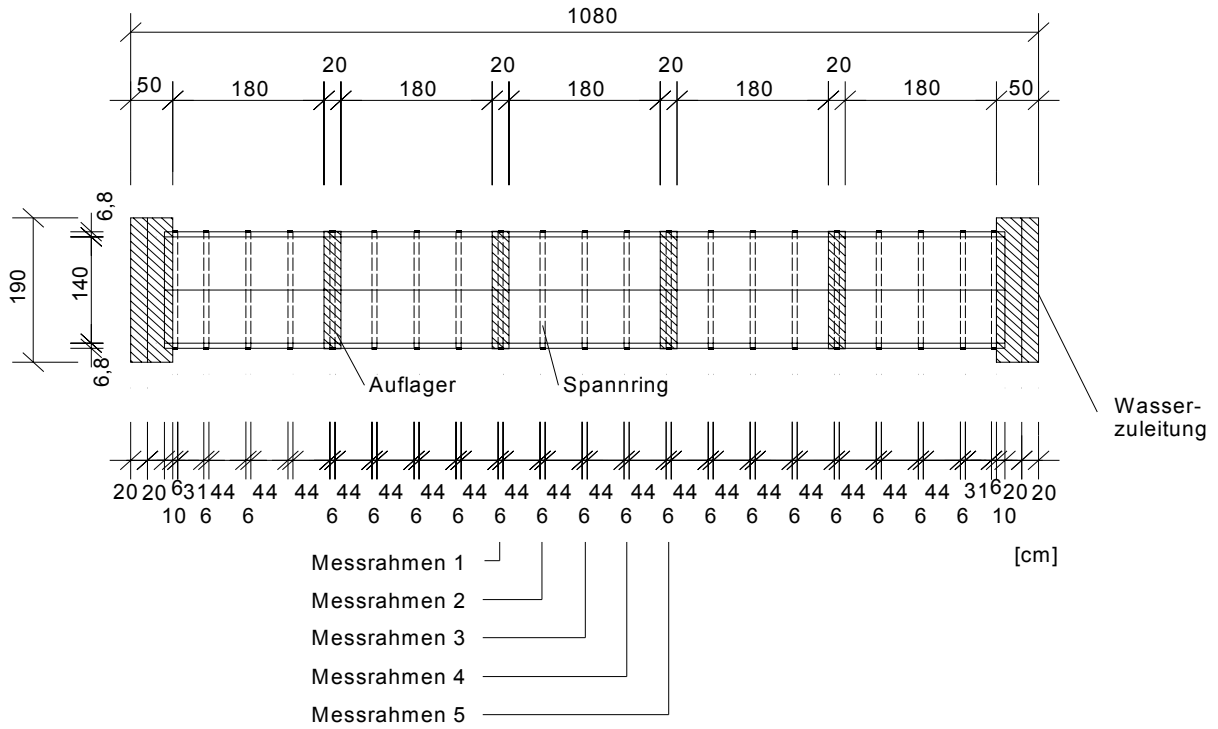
Versuchsstand: Draufsicht und Querschnitt (Messrahmen)
